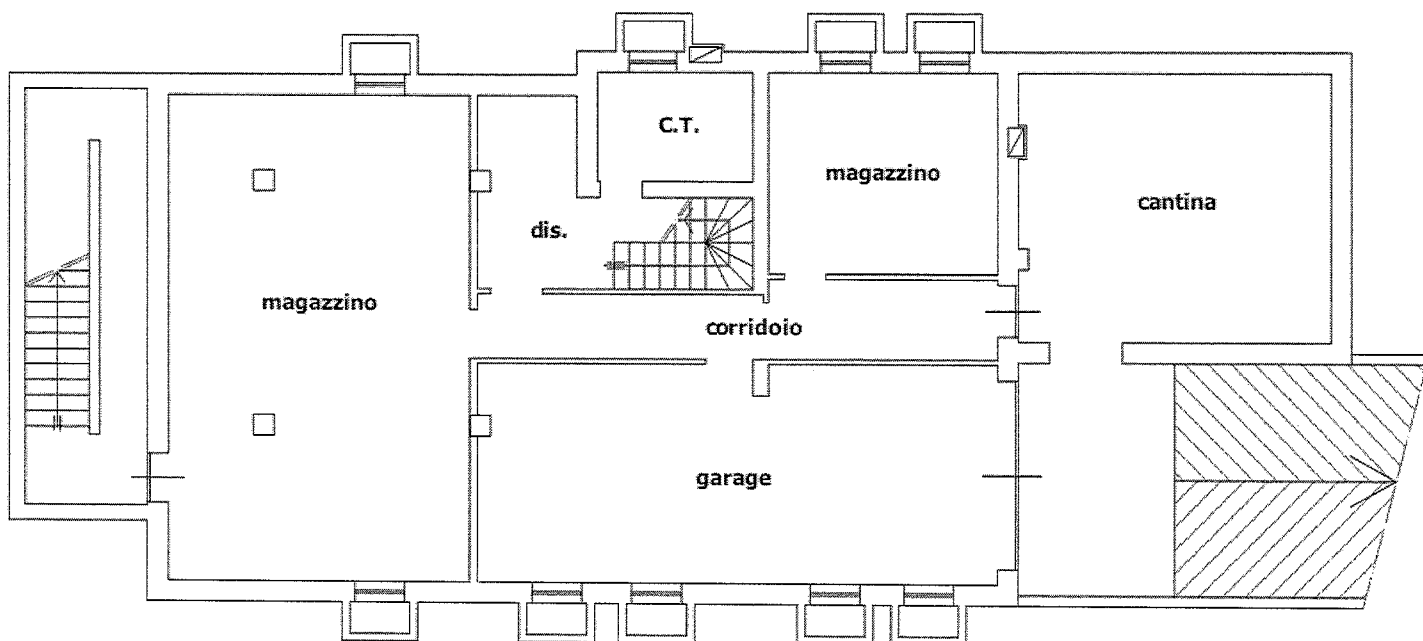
pianta piano interrato STATO ATTUALE (fuori scala)
